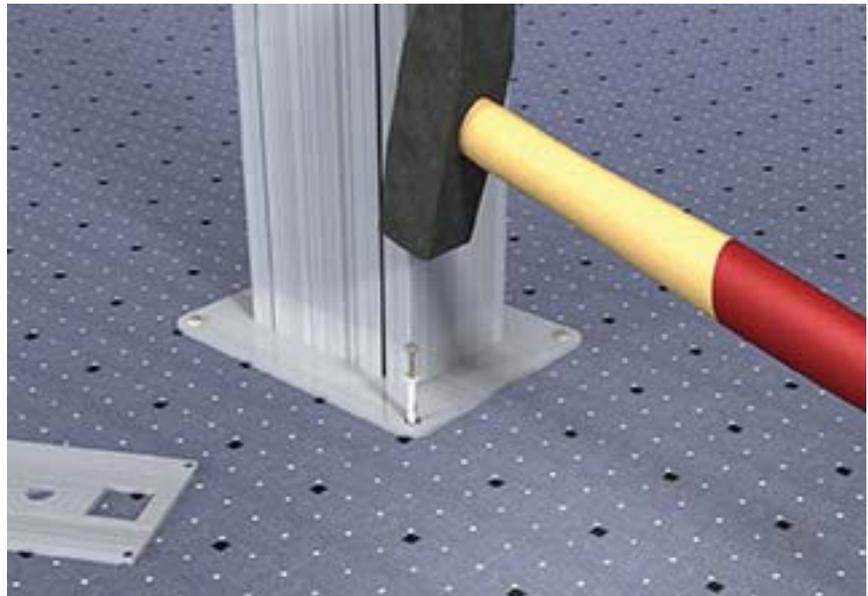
Montage einer Installationssäule mit übergreifender Bodenplatte
